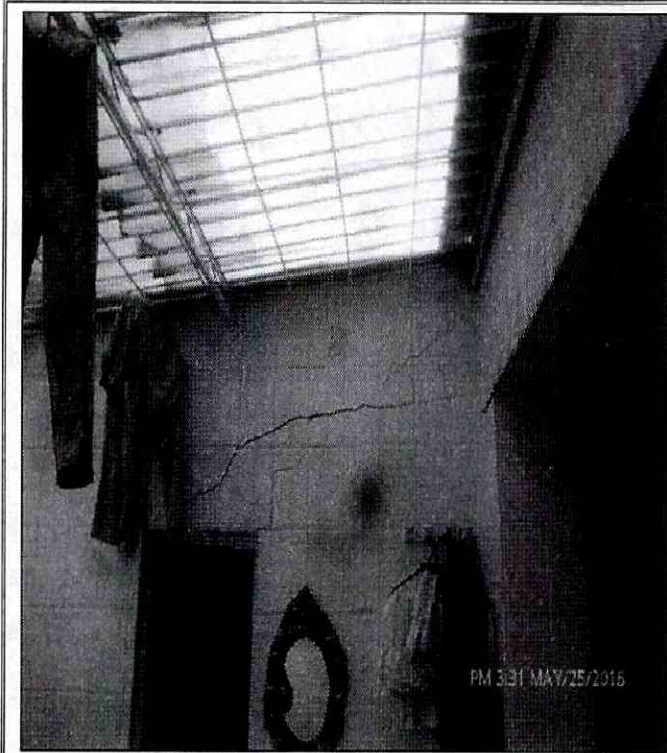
Grietas identificadas en muros de cerramiento y divisorios de la vivienda ubicada en el predio de la Calle 104 No. 58 A – 12, en el Sector Catastral Puente Largo de la Localidad Suba.
